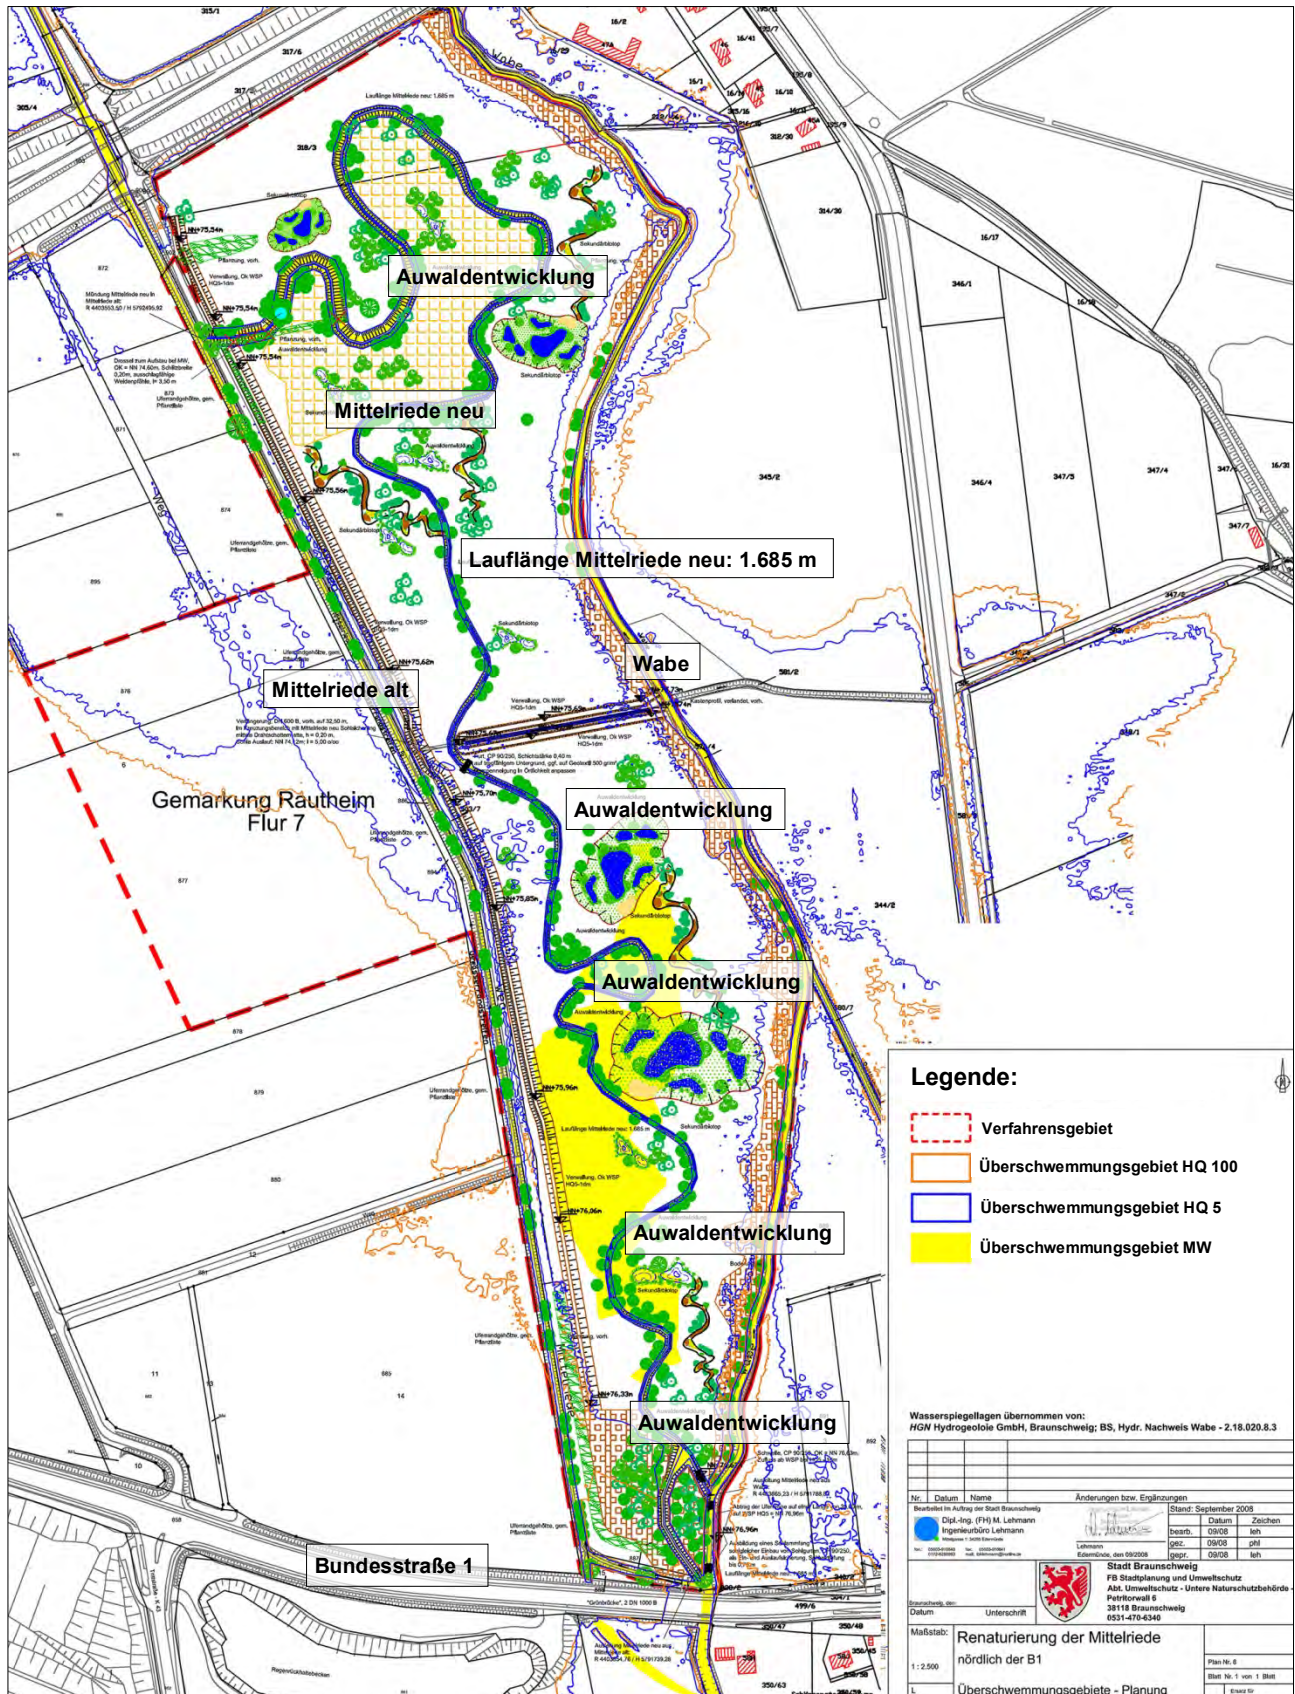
Lageplanausschnitt „Renaturierung der Mittelriede nördlich der B 1“. [3]
